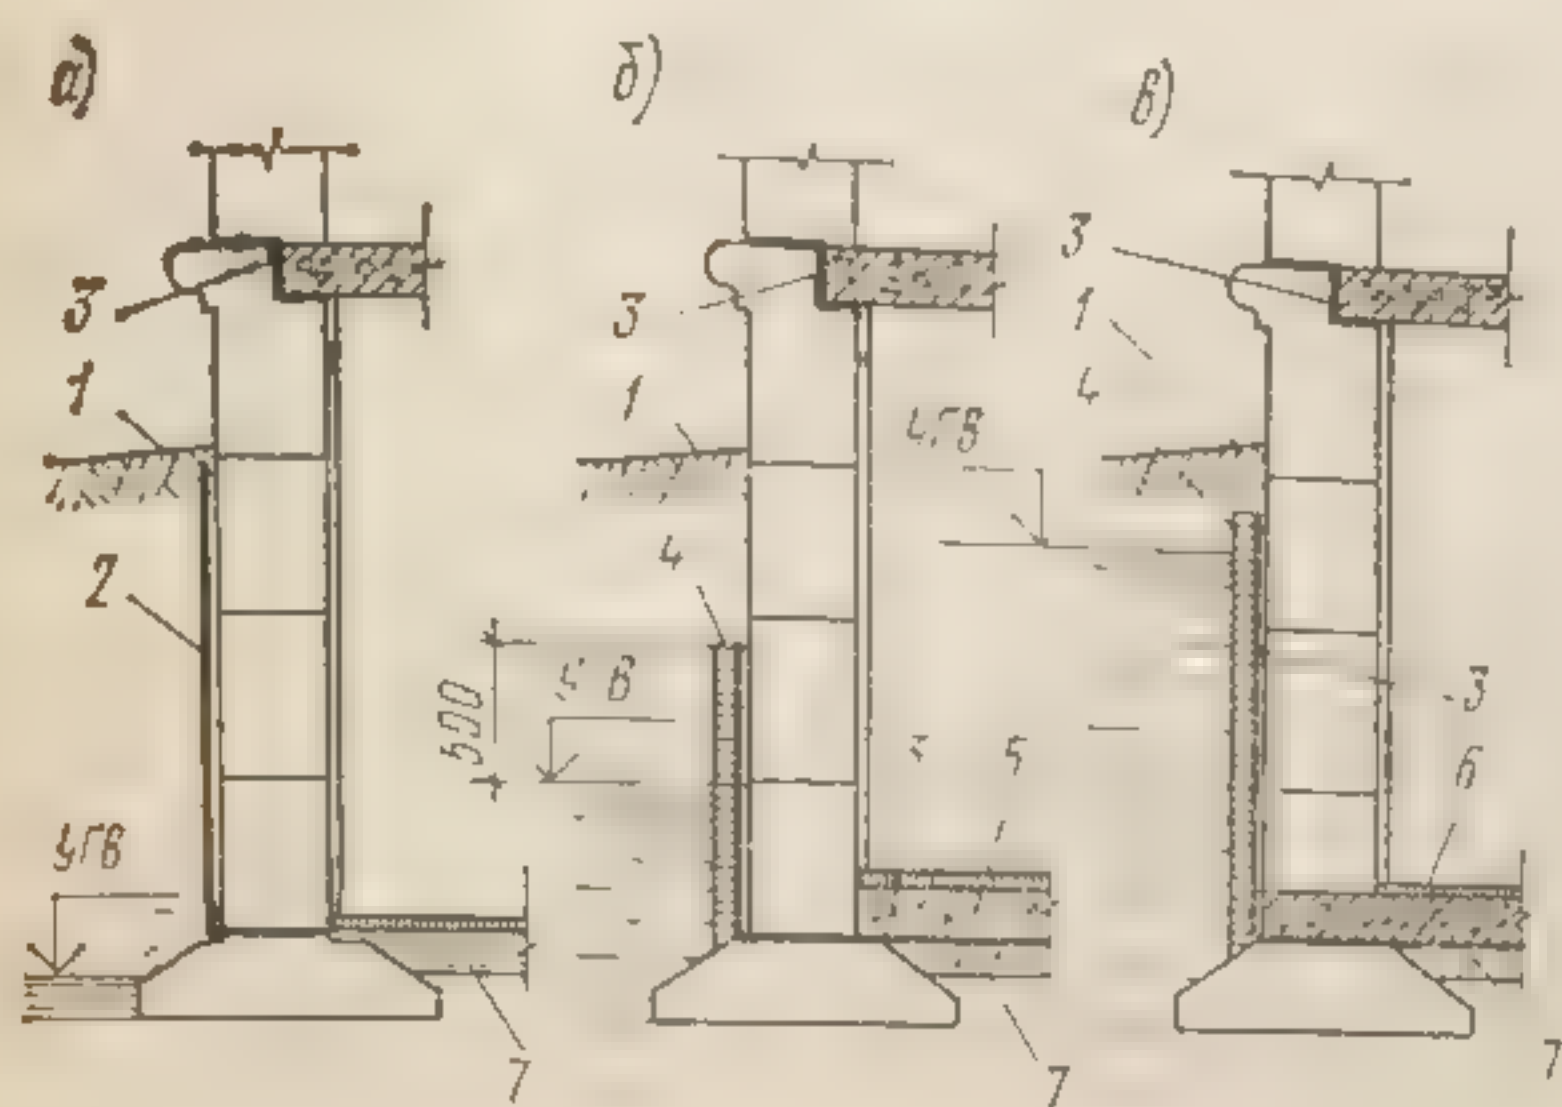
Гидроизоляция ленточных фундаментов в зданиях с подвалами:
